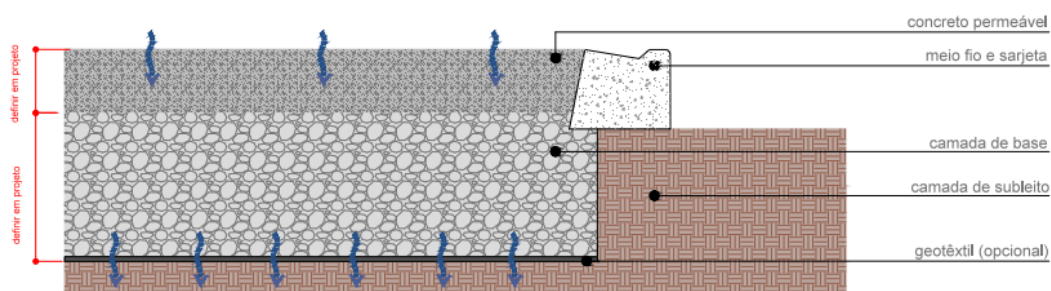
Pavimento com aplicação de concreto permeável com infiltração total no solo
